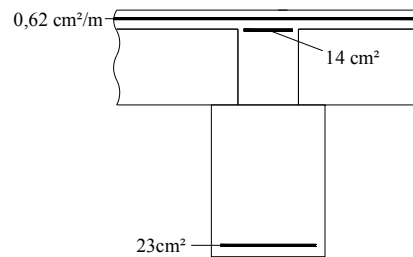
Armadura empregada no modelo *concreto armado composta*.
